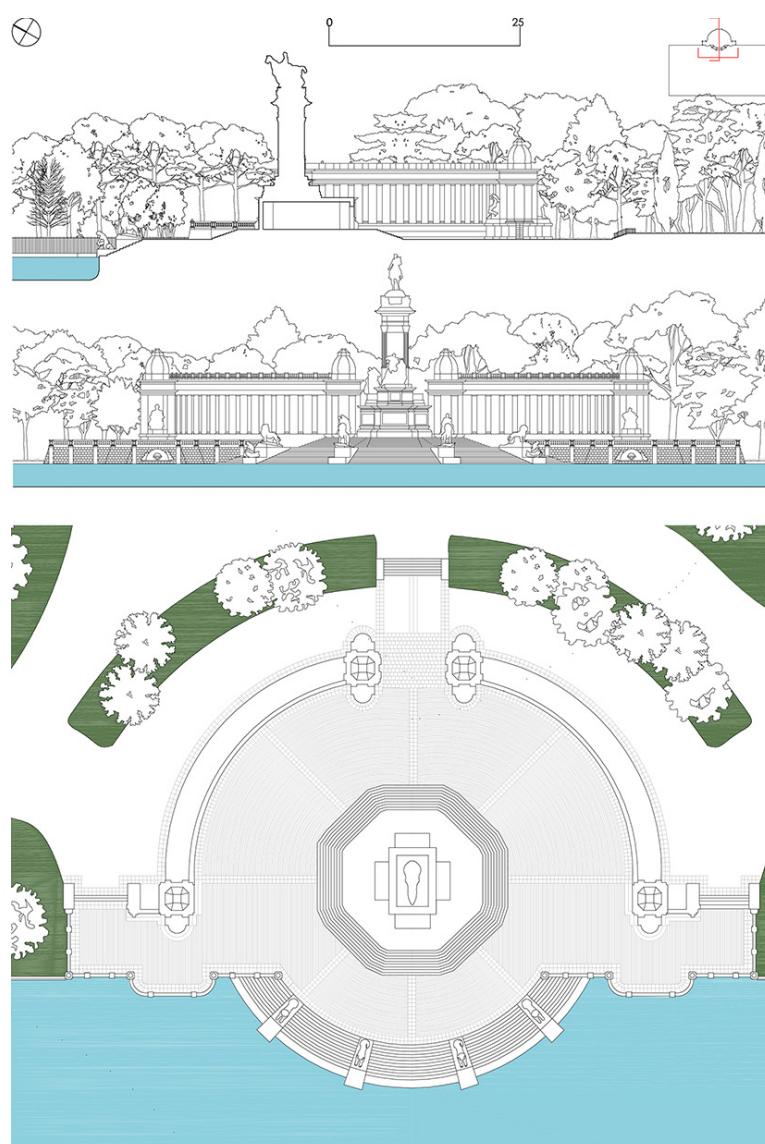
Il Parco del Retiro a Madrid, la *Estanque Grande*, pianta delle coperture, sezione A-A' (in alto), sezione B-B' (in basso).
